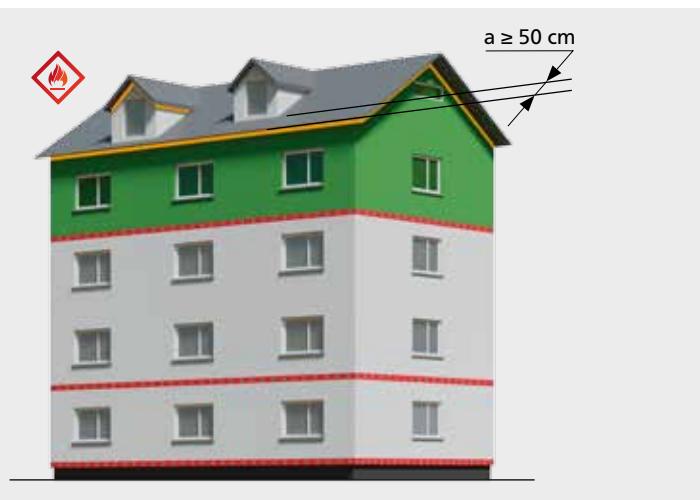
Ausführung von Abschlussriegeln unterhalb eines „ausgebauten“, brennbaren Steildaches mit Aufenthaltsräumen und Dachgauben, die mit EPS-WDVS gedämmt sind
